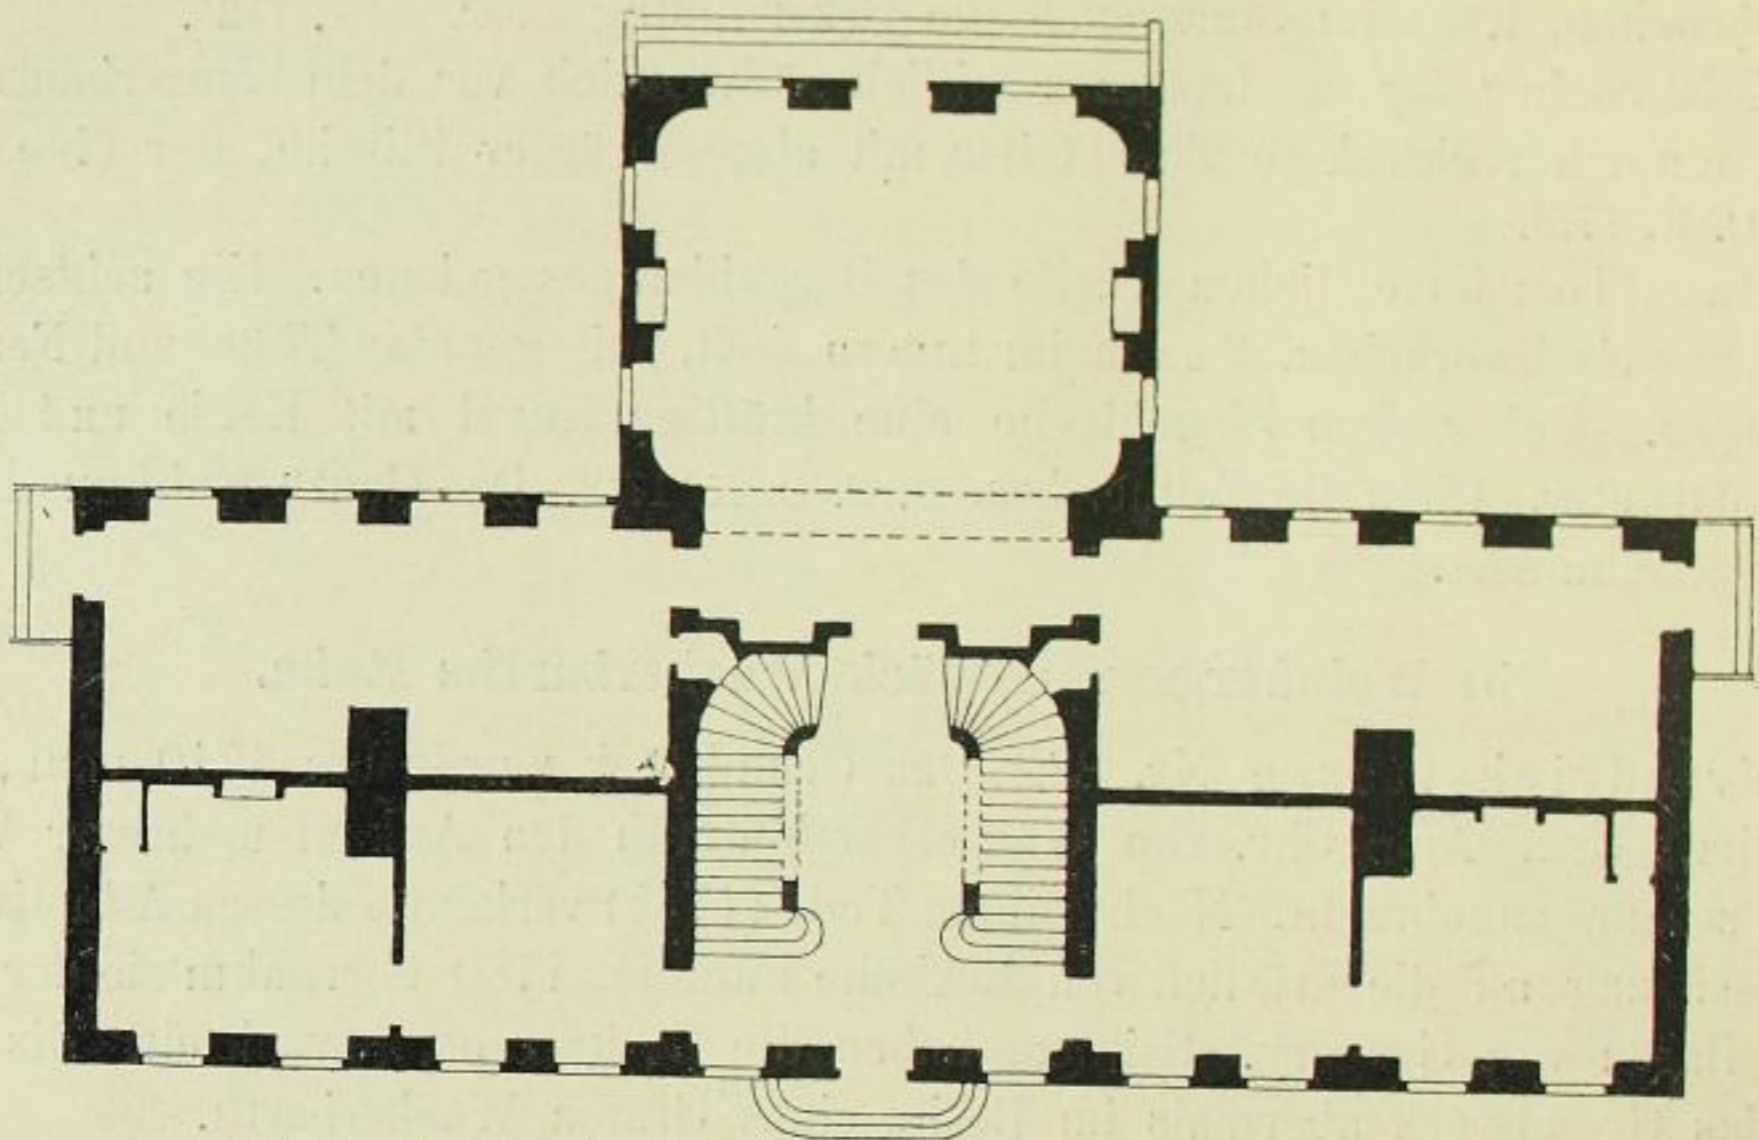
Niederlössnitz, Wackerbarths Ruhe, Grundriss des Erdgeschosses.
